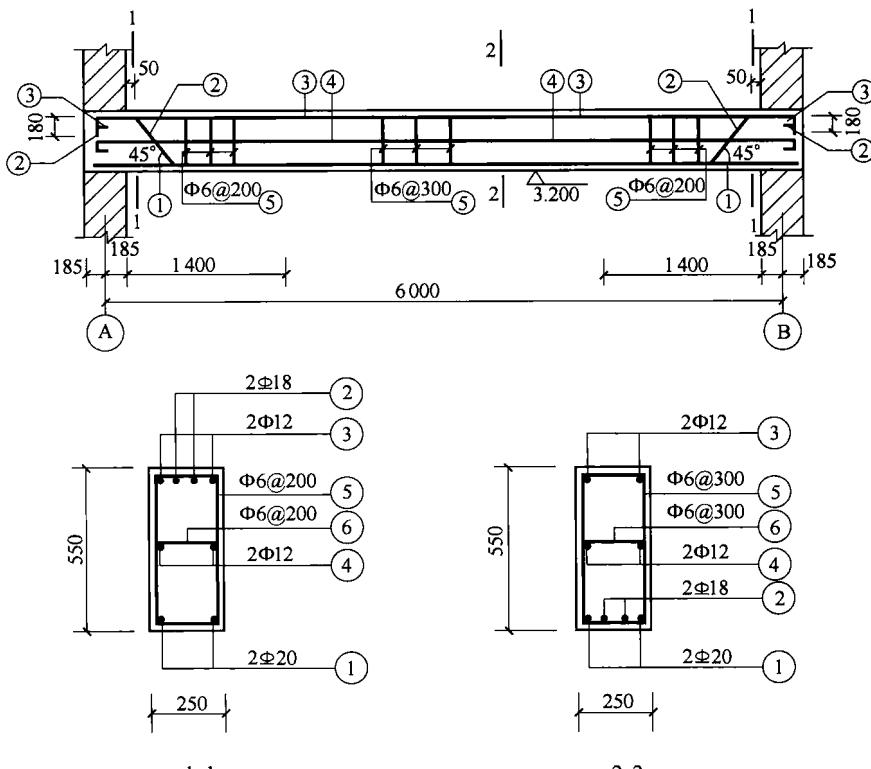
现浇钢筋混凝土简支梁(L1)配筋图
